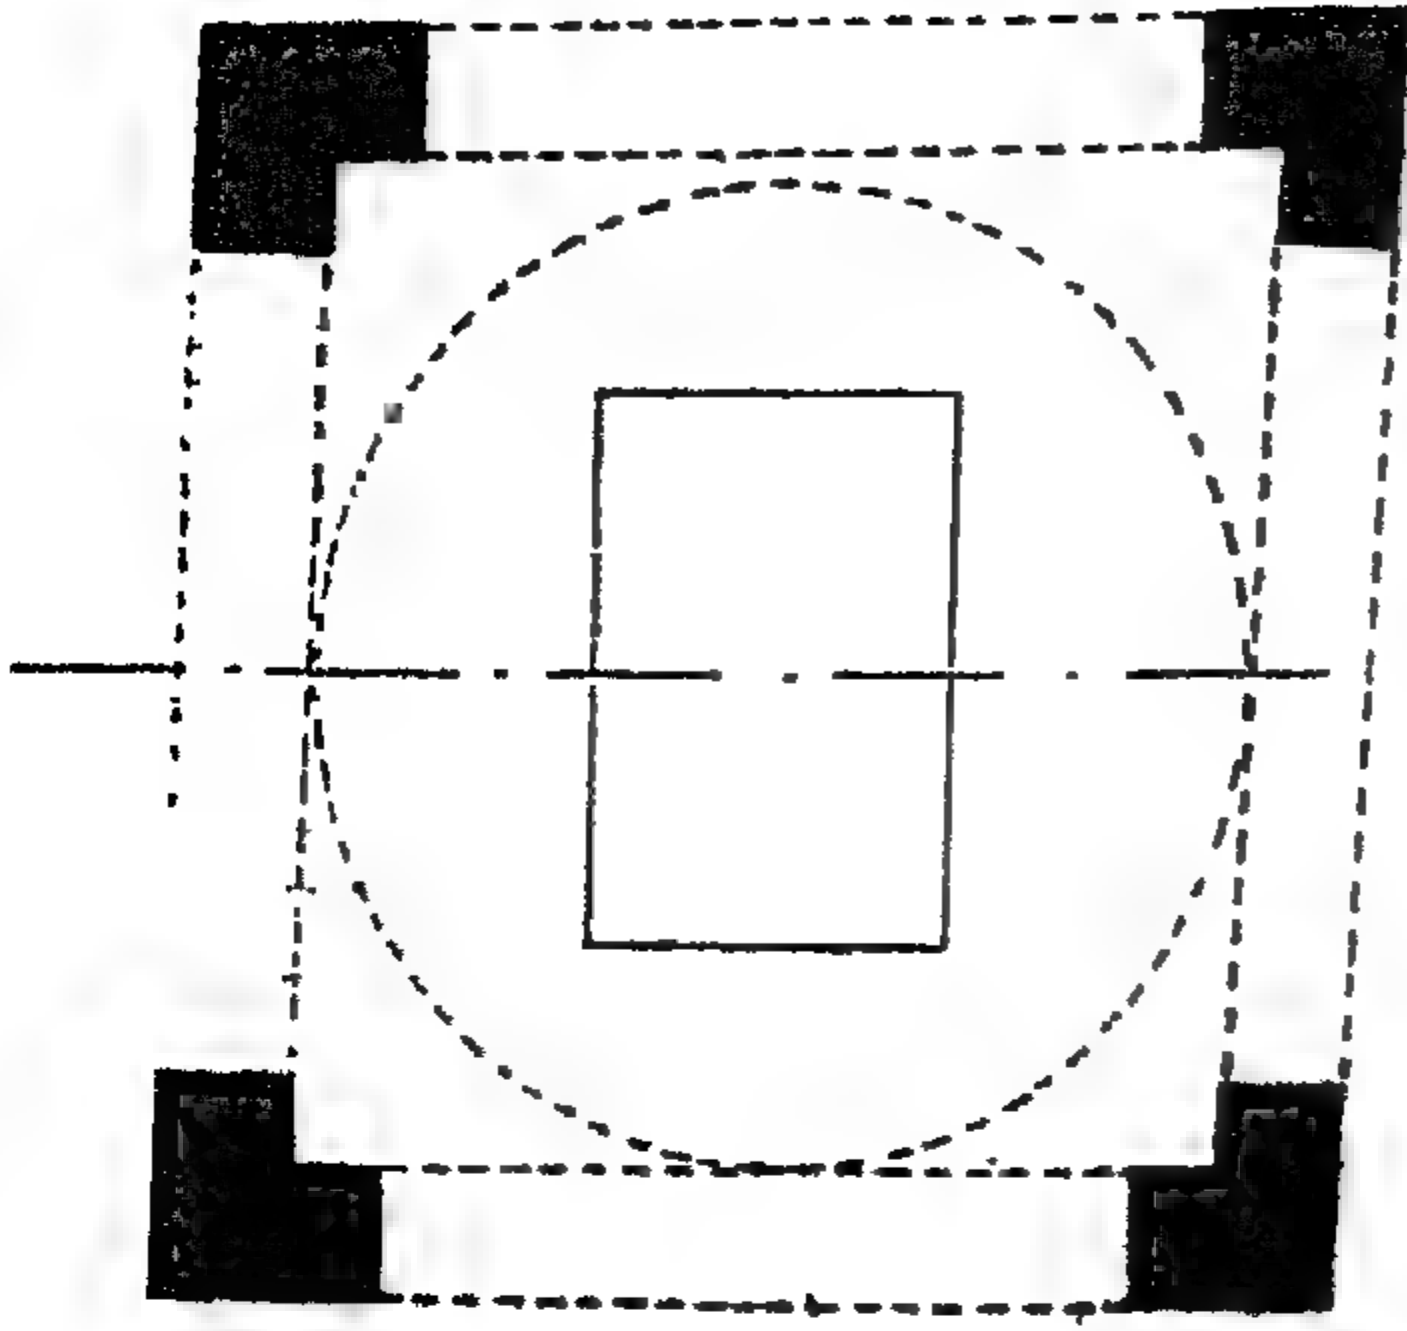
مسقط أفقي لقبة الشيخ الروبي بالفيوم (عن إبراهيم عامر).
